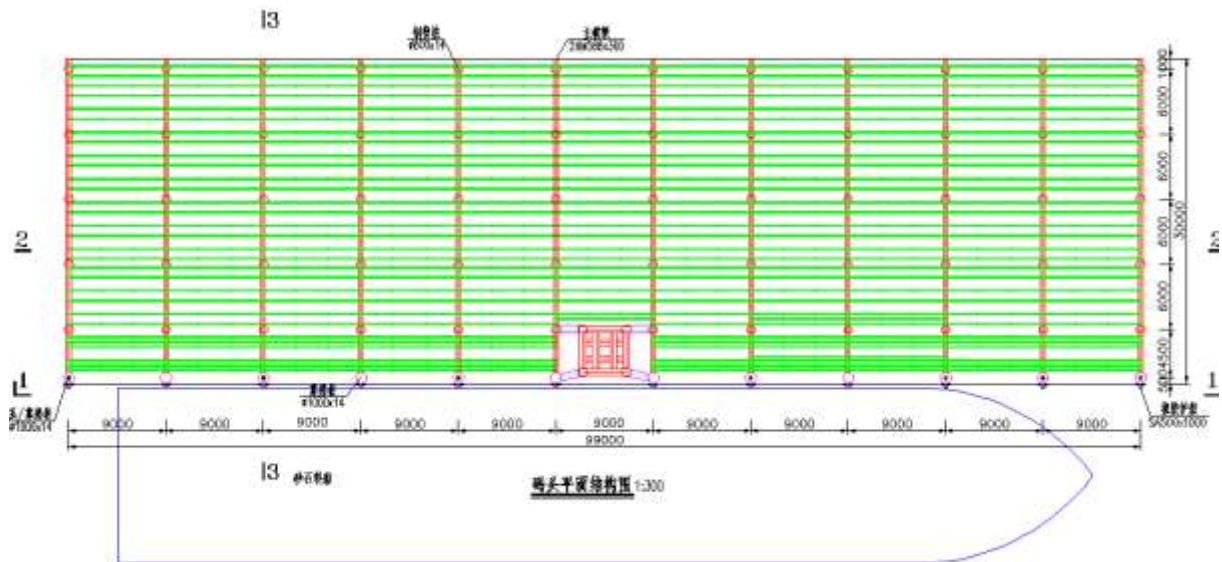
水上材料码头片面图（尺寸单位：mm）
